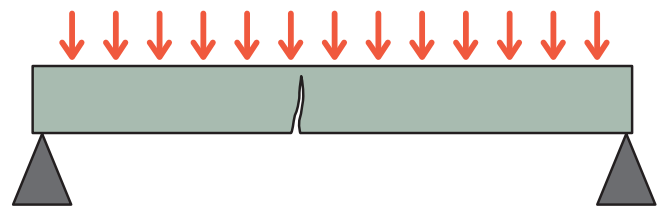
Cette fissure, qui apparaît sensiblement à mi-portée de la poutre, fait suite à son fléchissement. La résistance des matériaux enseigne comment calculer le moment de flexion, puis les contraintes de compression dans la partie haute de la poutre, et les contraintes de traction en partie basse. Ce sont ces dernières qui sont à l'origine de la fissuration.
